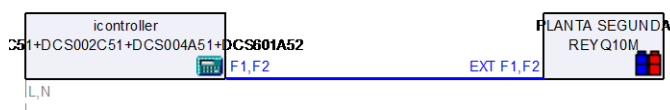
Esquema conexión control centralizado VRV. PLANTA SEGUNDA
